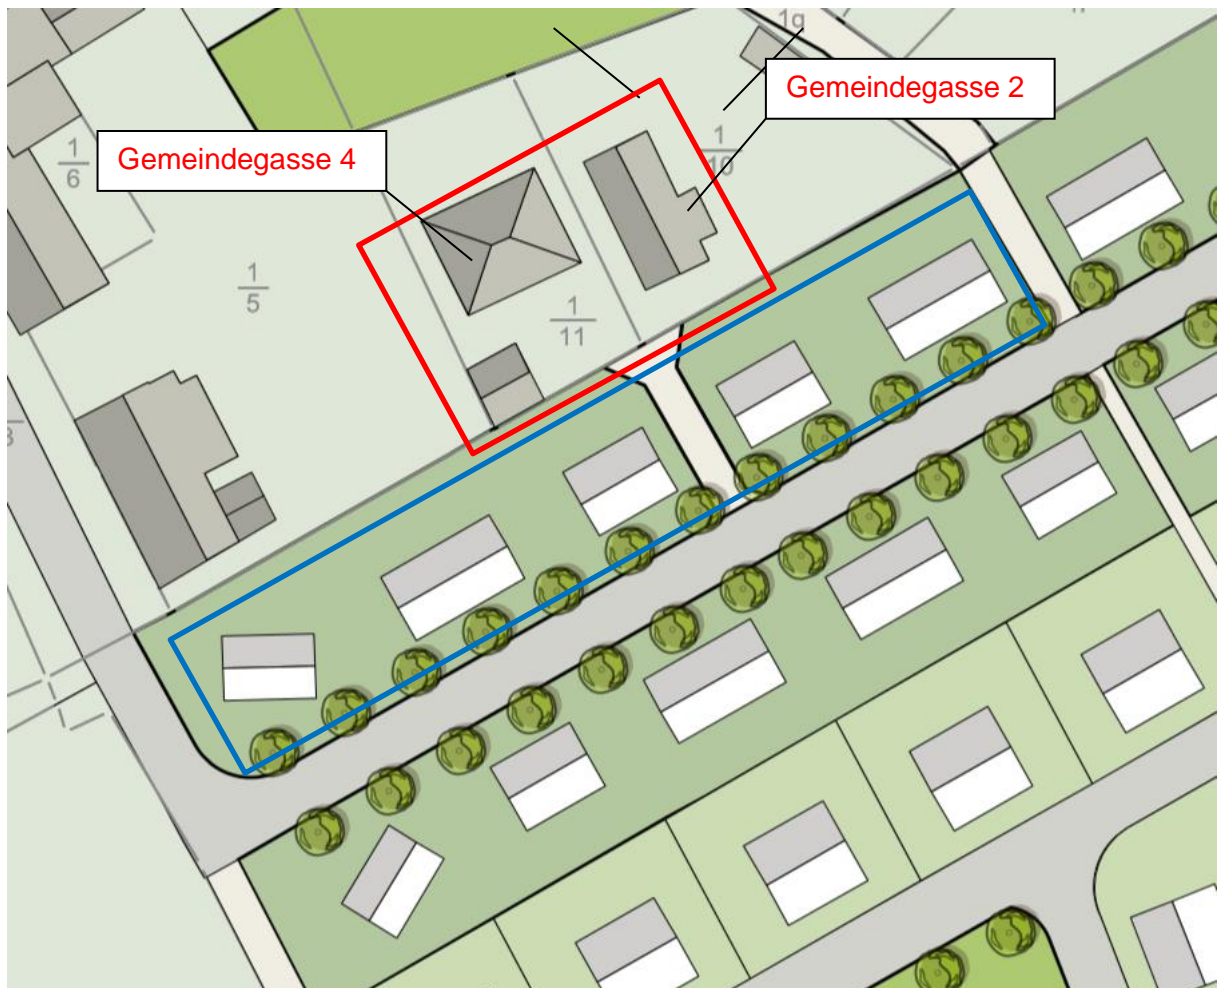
Lageplan mit Darstellung des Vorhabens (blau) und dem zu untersuchenden betroffenen Bereich (rot)¹
